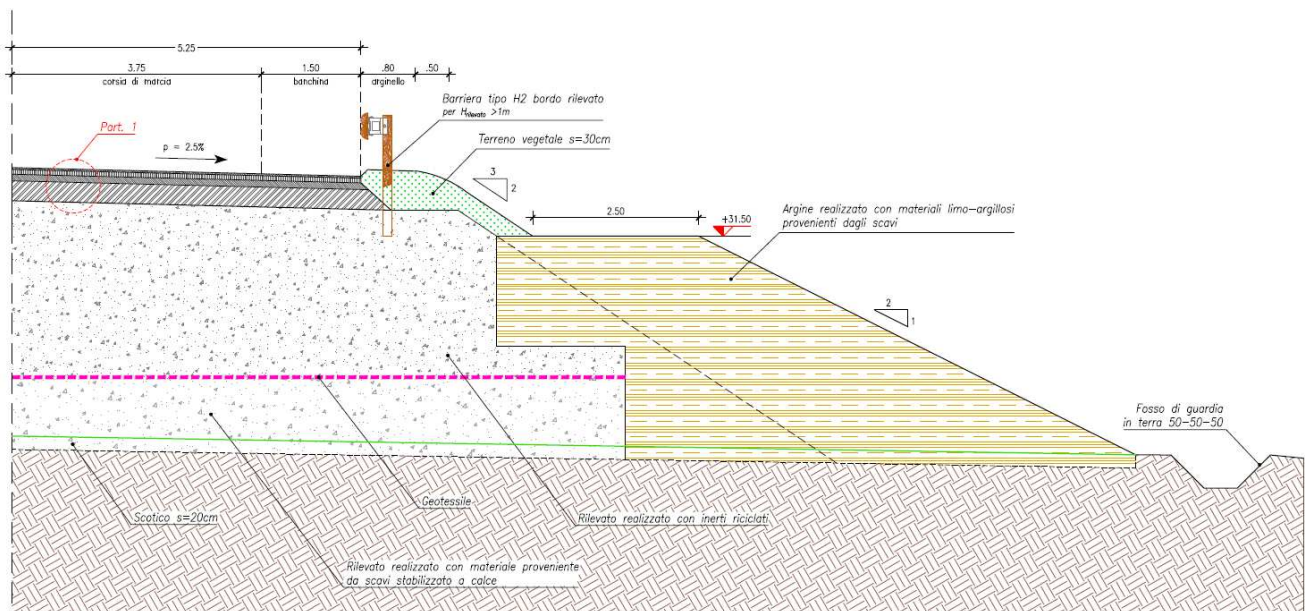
Sezione tipo tratto compreso all'interno delle casse di espansione
